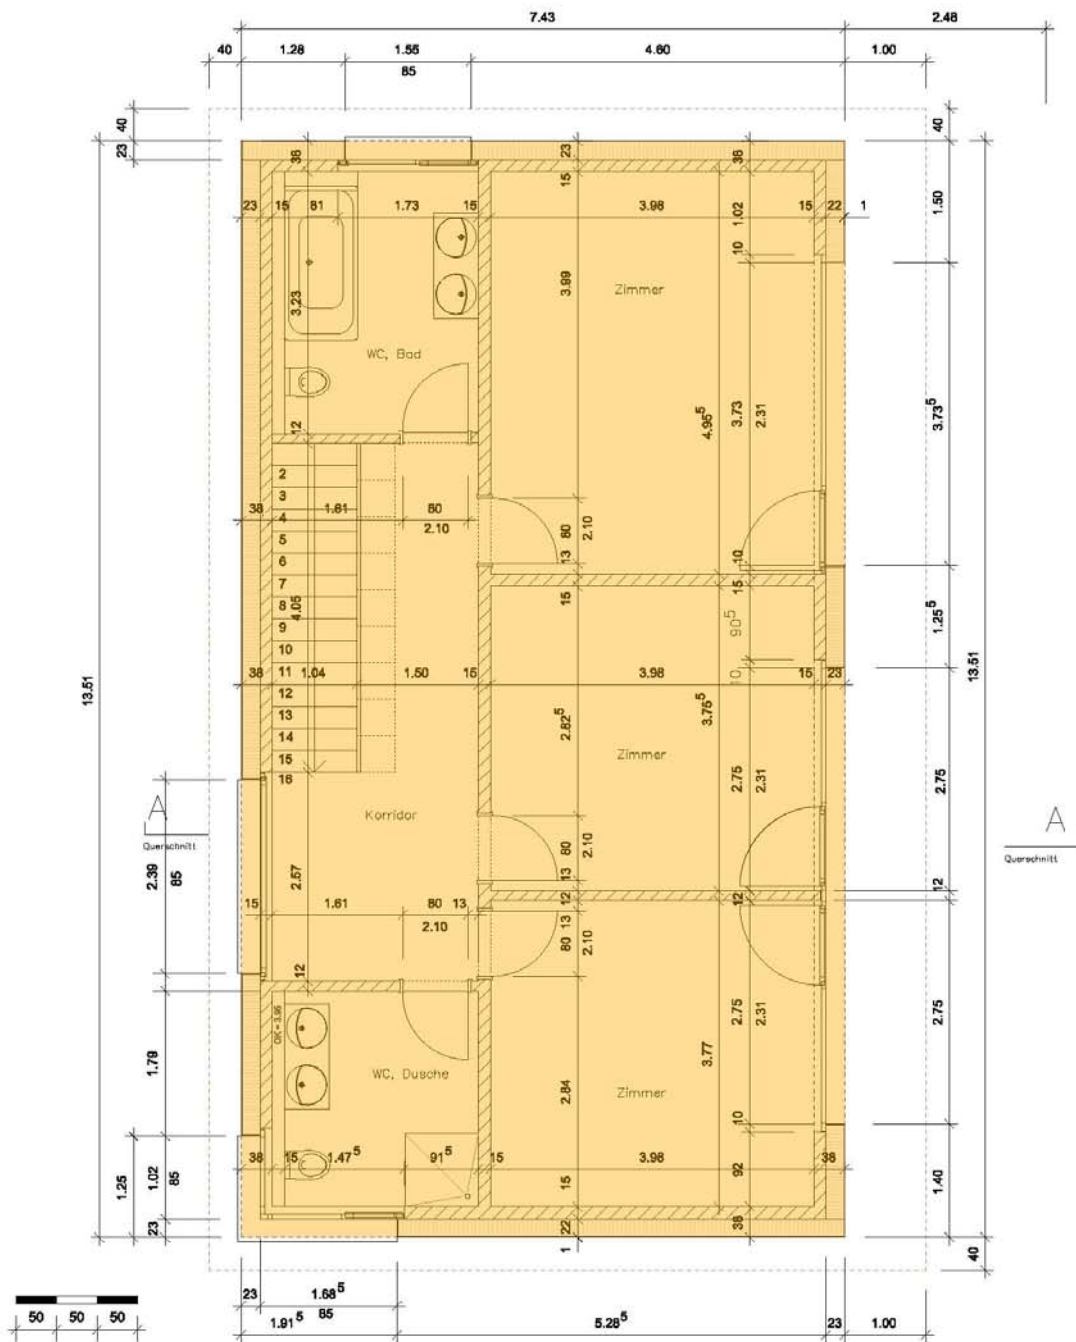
Grundrissplan EFH Obergeschoss
